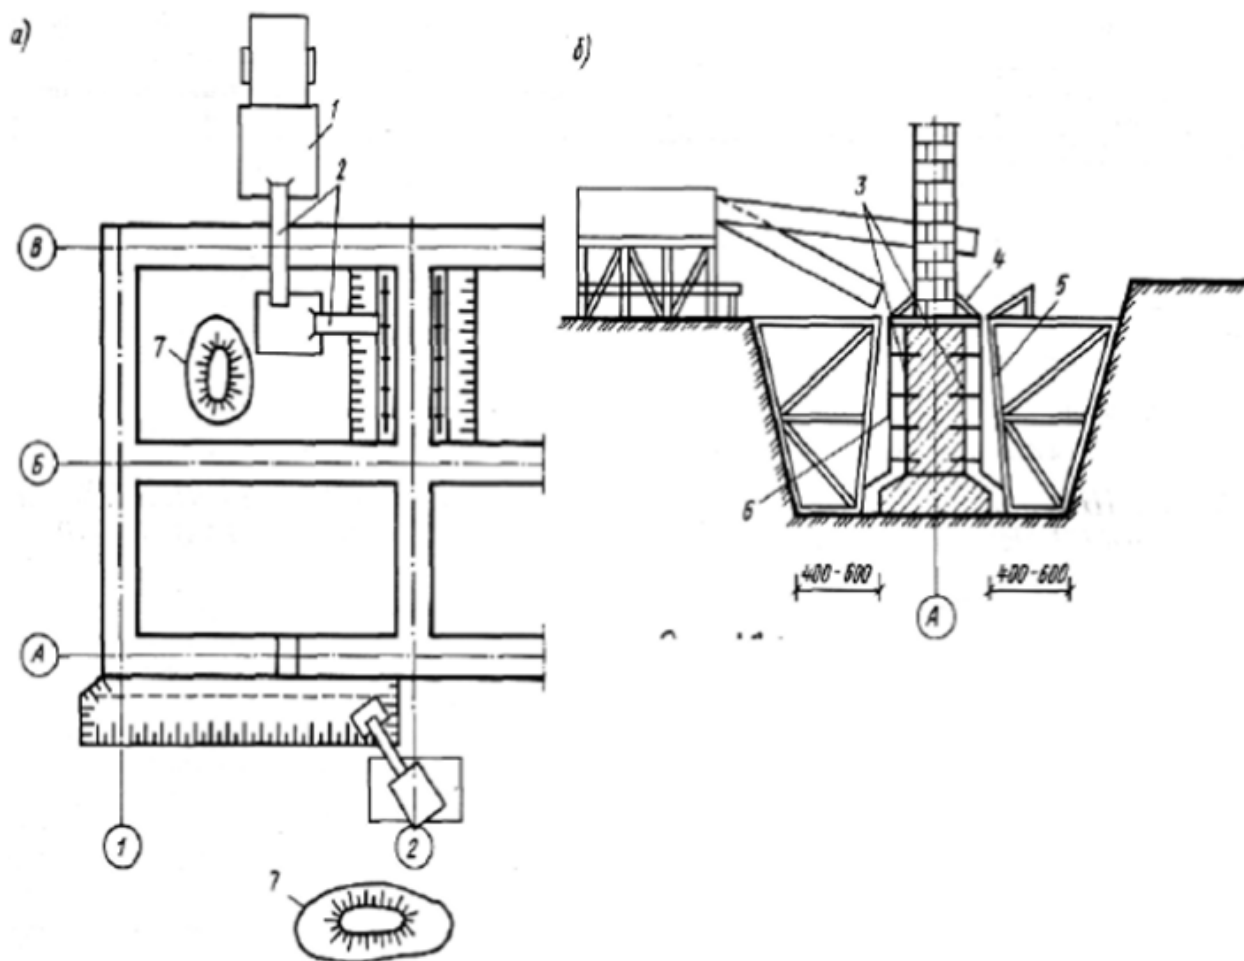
Общая схема организации работ по усилению фундаментов сооружения: а-фрагмент плана фундаментов; б - схематический разрез конструкций перед началом бетонирования; 1-приемный ящик; 2-лоток; 3-арматурные анкеры; 4-опорная балка; 5-щитовая опалубка; 6-арматурная сетка; 7-грунт для обратной засыпки
